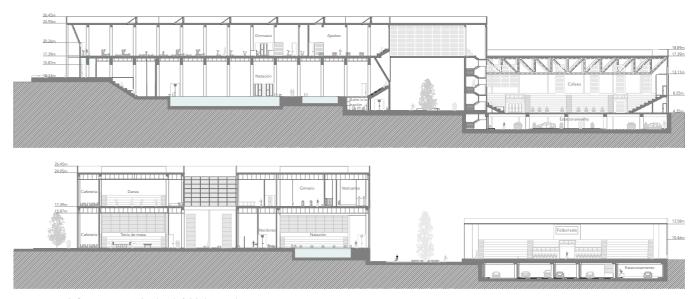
Secciones - 01 (sur) / 02 (oeste) Elaborado por: Autor
